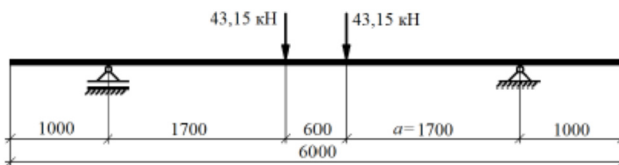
Расчётная схема испытания фибробетона с использованием различных видов фибры
